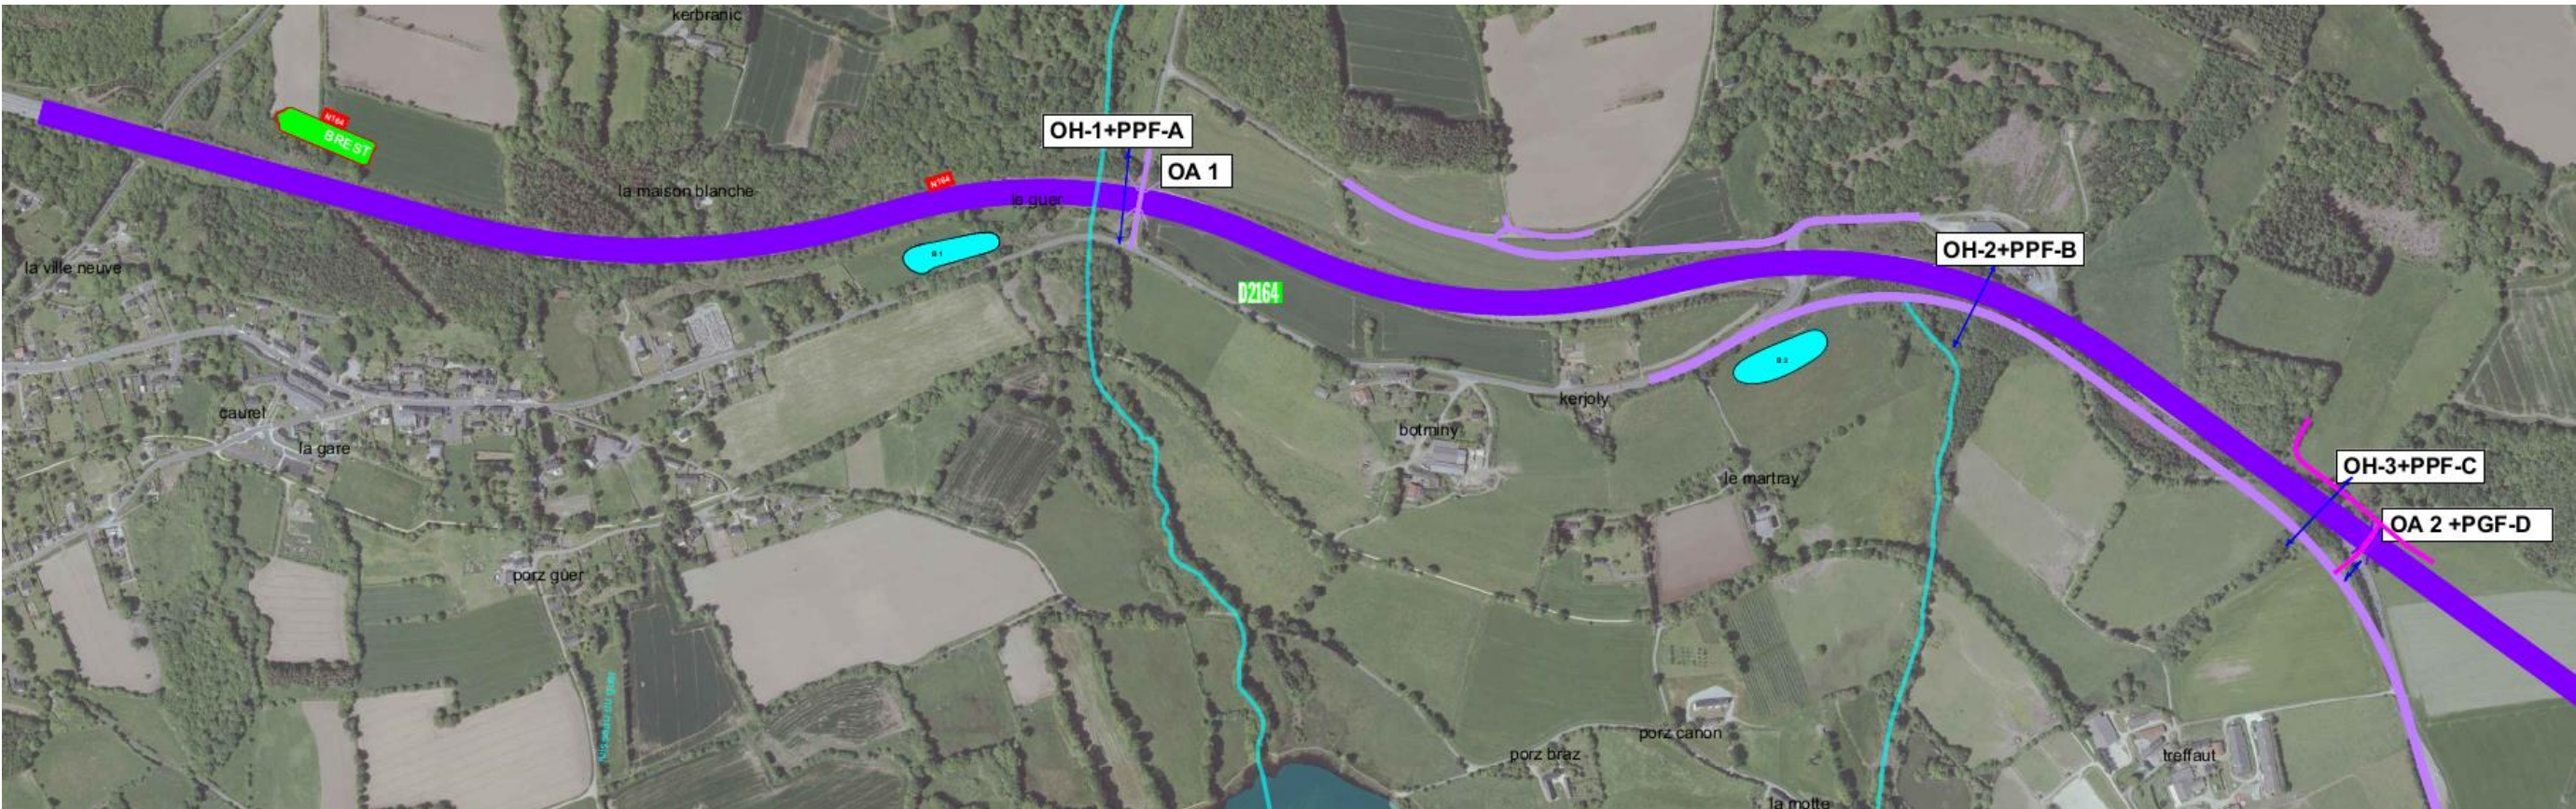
Plan général de travaux – Planche 1 (Source : SIR)
